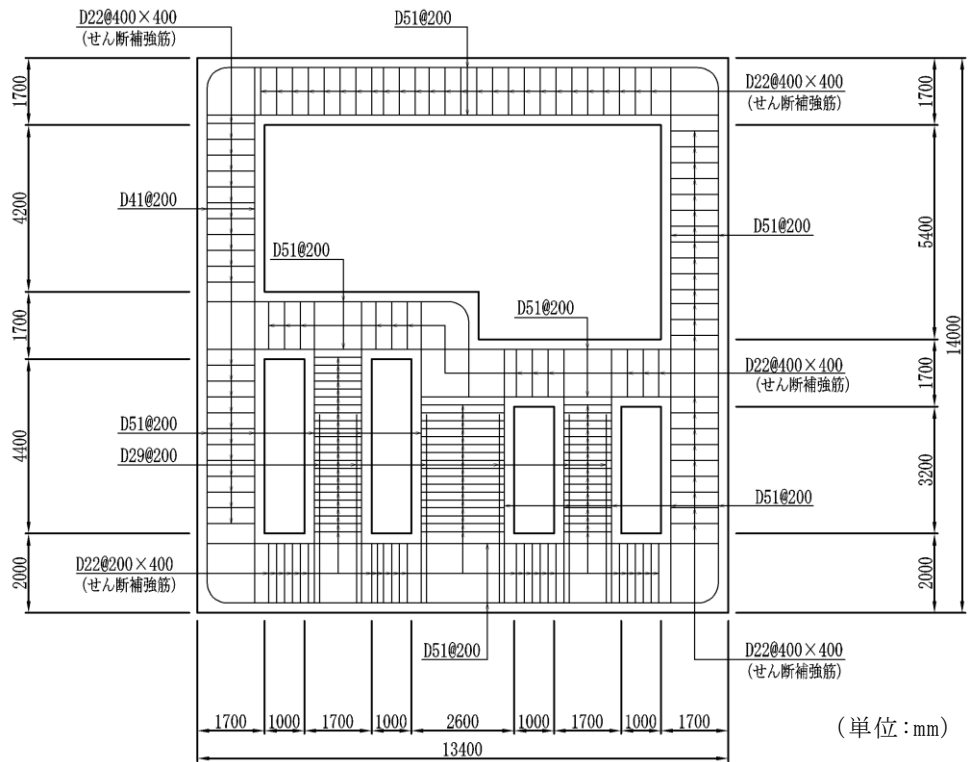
第 1 ベントフィルタ格納槽 概略配筋図 (B-B 断面)
